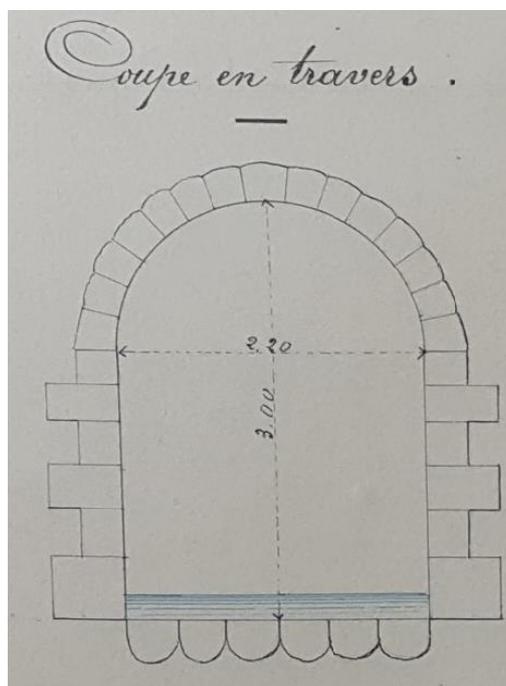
Coupe en travers du canal de fuite rive droite, Plan d'archives daté de 1878
